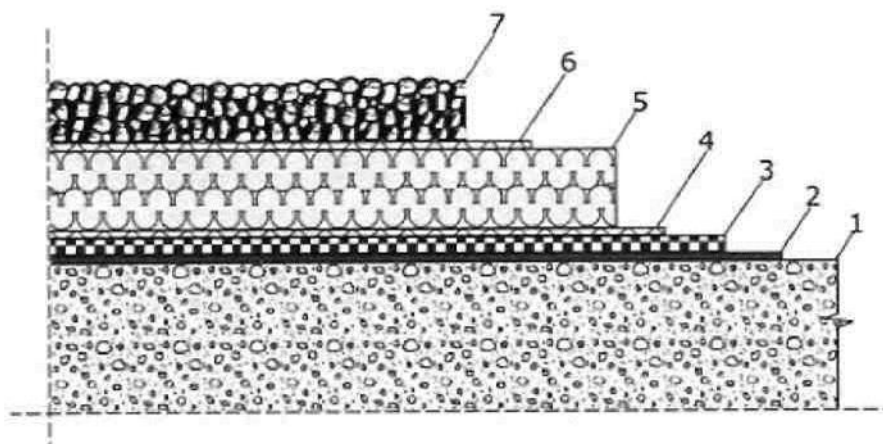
Гидроизоляция перекрытия внутри здания
